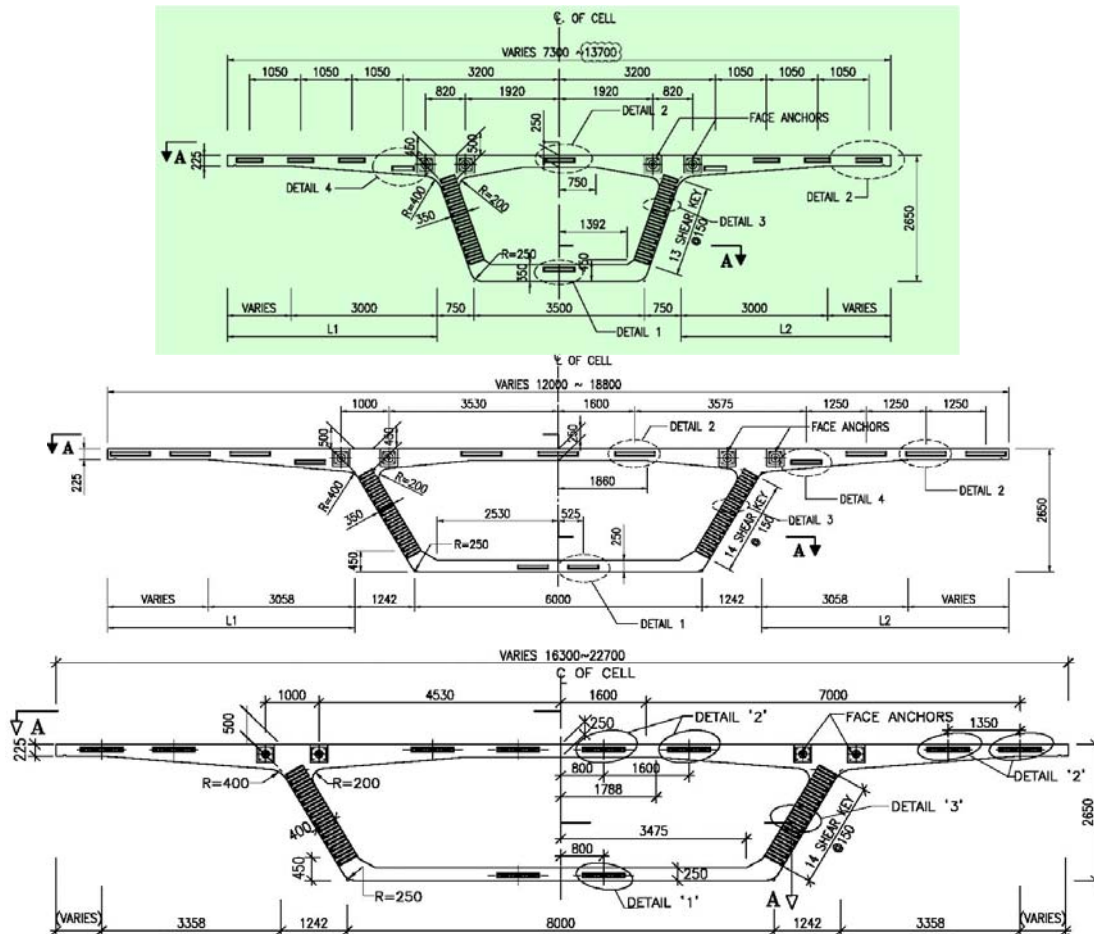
Tipos de dovelas prefabricadas A, B y C, de canto constante.
